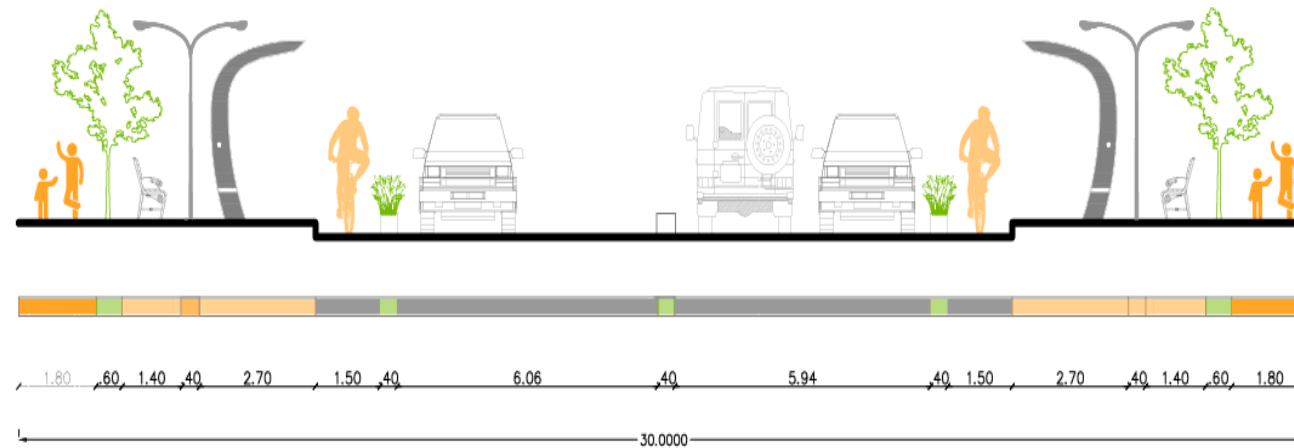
116: Vía e45 – Elevación, Escala 1:200
